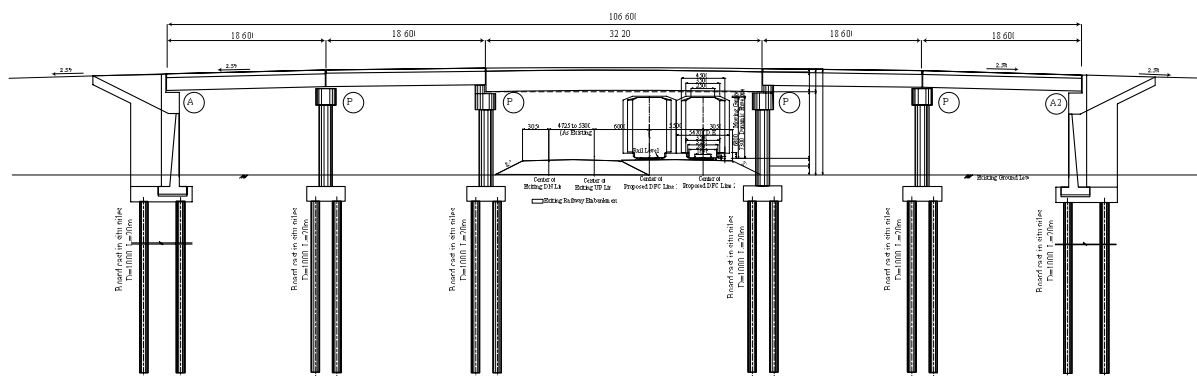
JST による ROB 標準側面図(都市部・郊外部)
